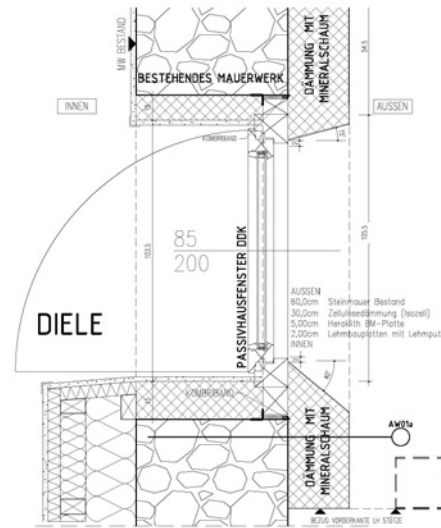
Horizontalschnitt: Übergang Innendämmung
